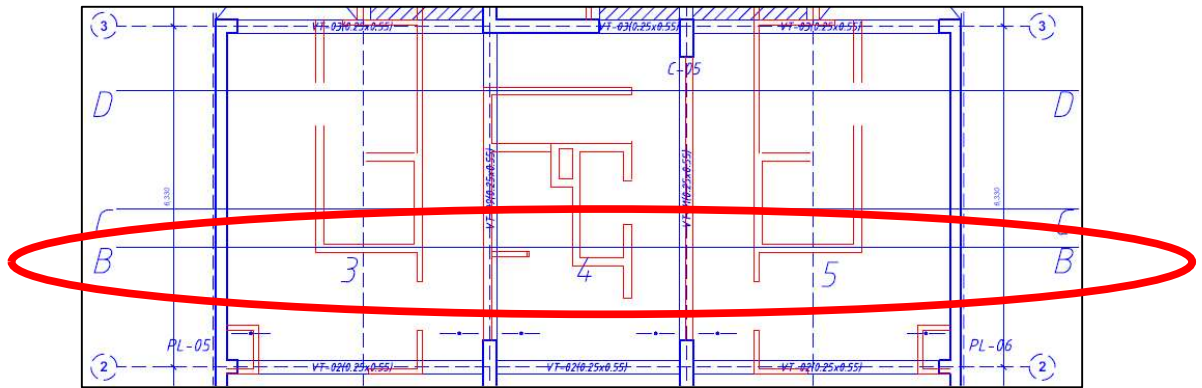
Plano en planta losa aligerada X-X ejes A-F/3-4
